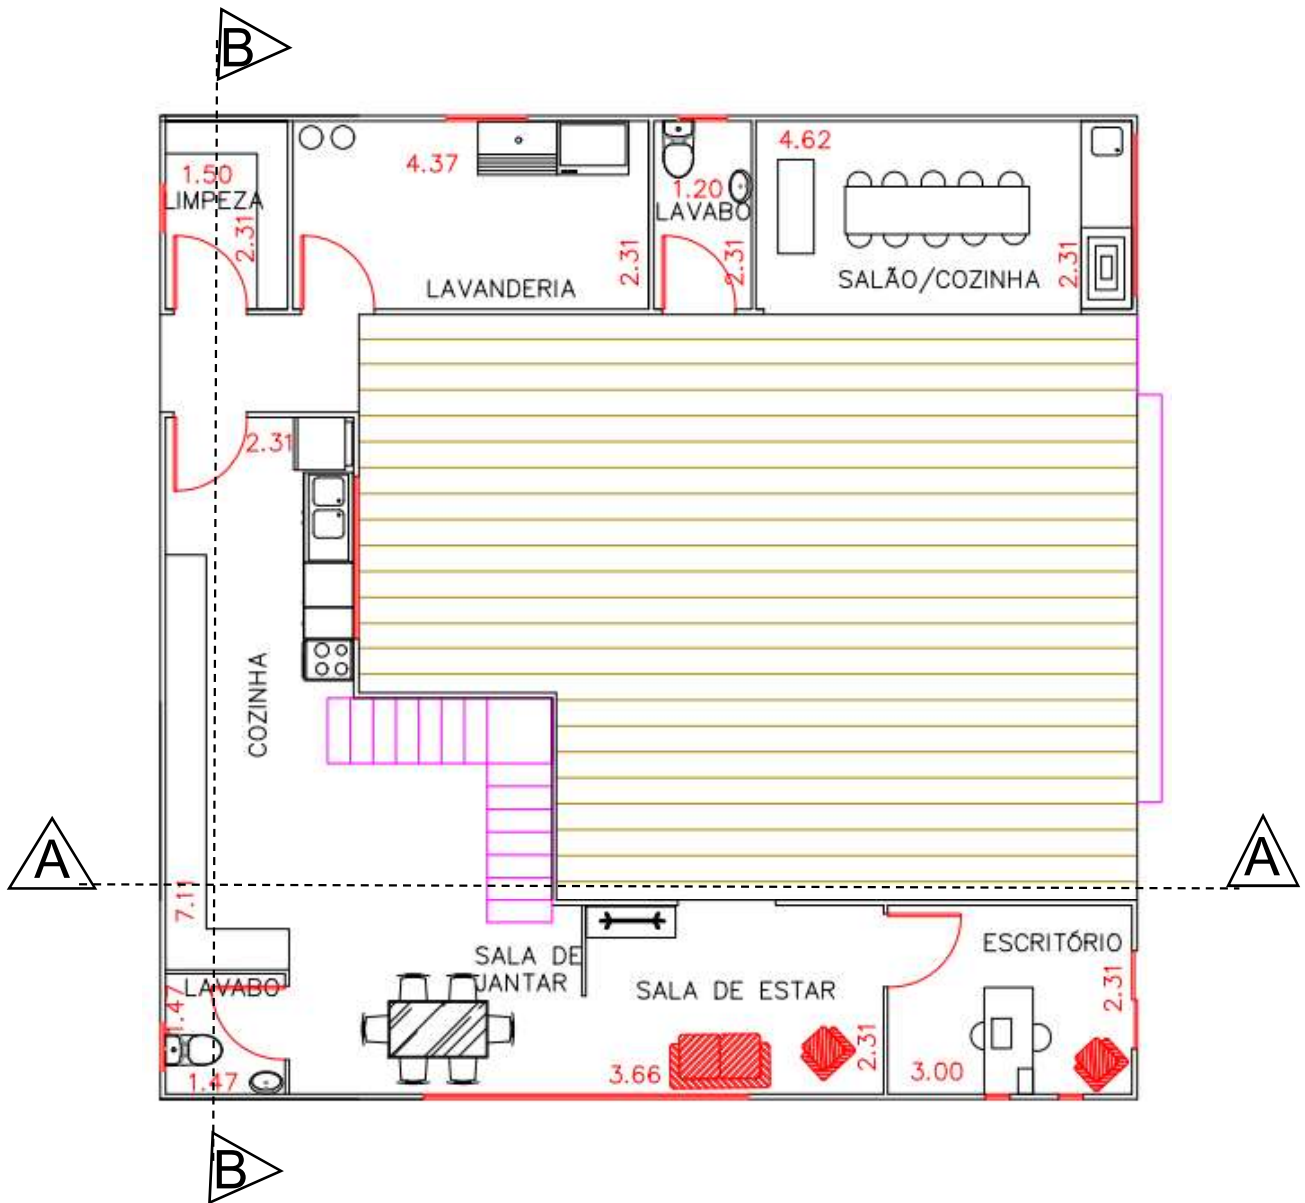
PROJETO, PAVIMENTO TÉRREO.
